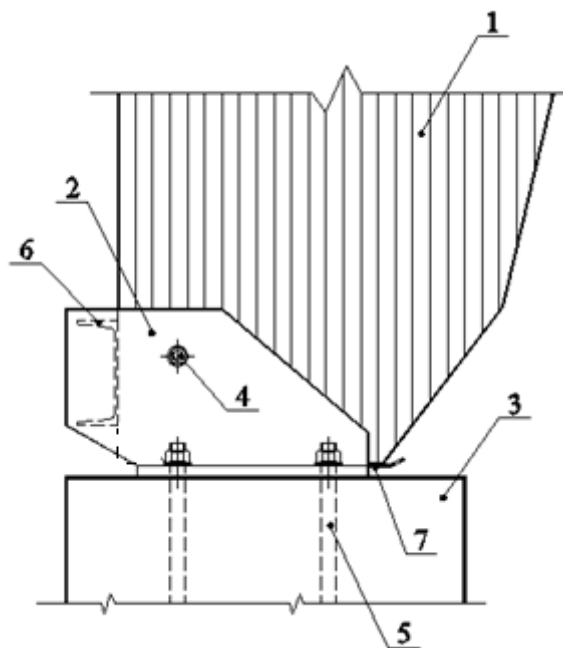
Схема узла соединения стойки рамы с фундаментом с использованием стальных уголков
